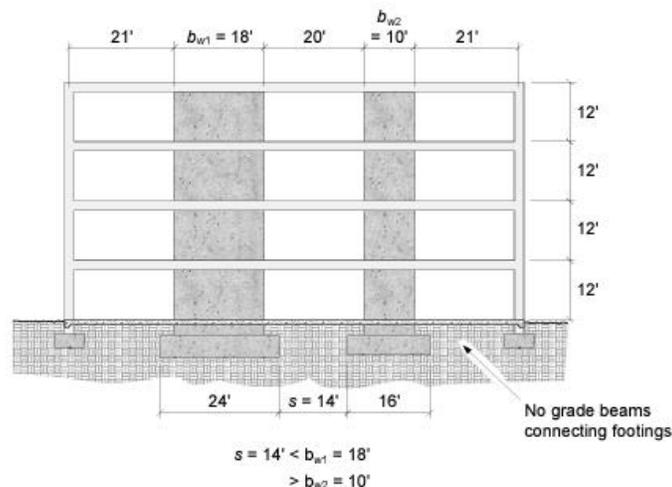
Ejemplo de una cimentación y superestructura donde no se permite la amortiguación de la cimentación porque las zapatas no conectadas están demasiado cerca.
